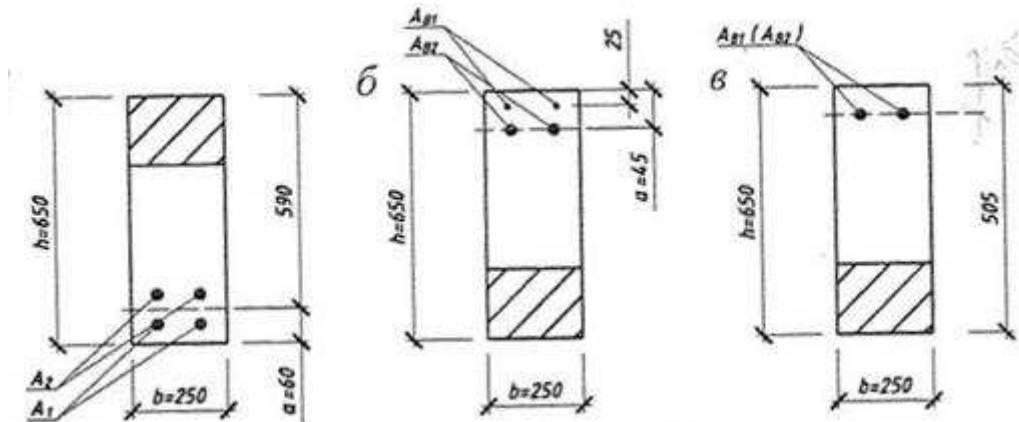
К подбору продольной арматуры в ригеле
